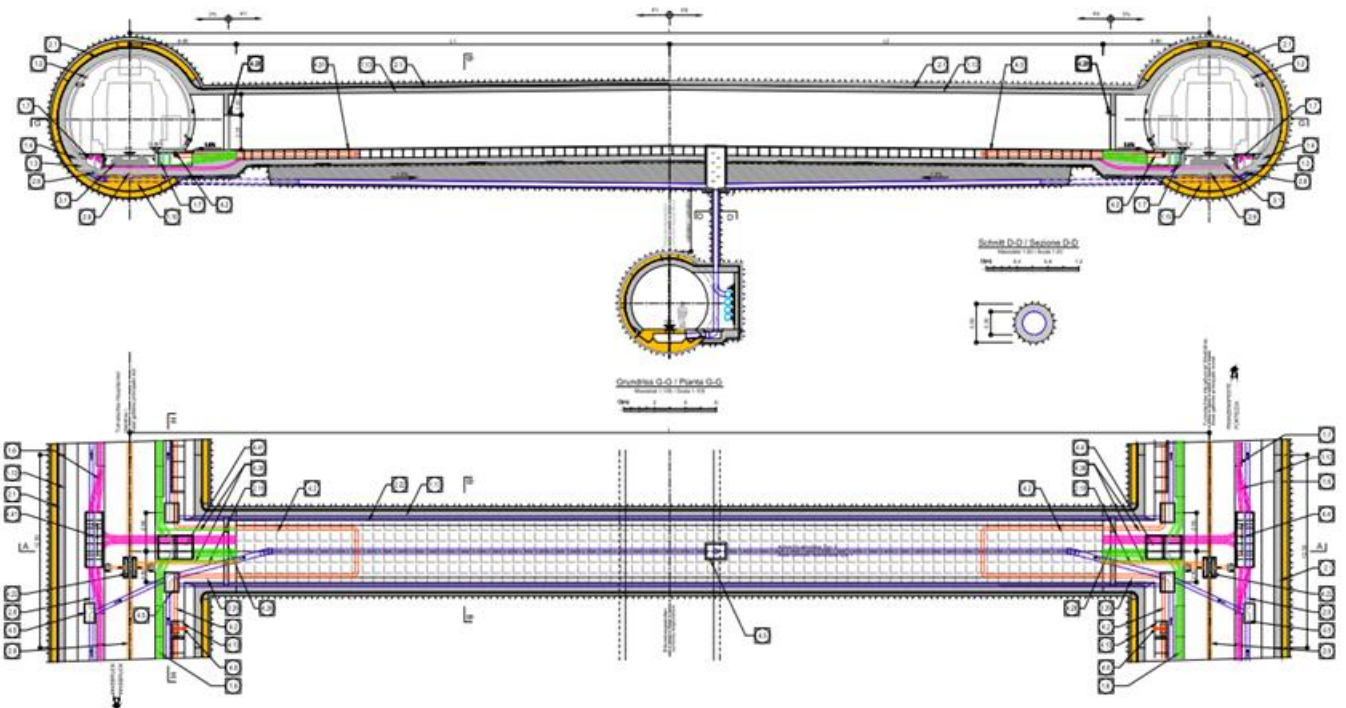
Querstollen Typ 1, mit Abfluss zum Erkundungsstollen. Grundriss und Längsquerschnitt [120].
